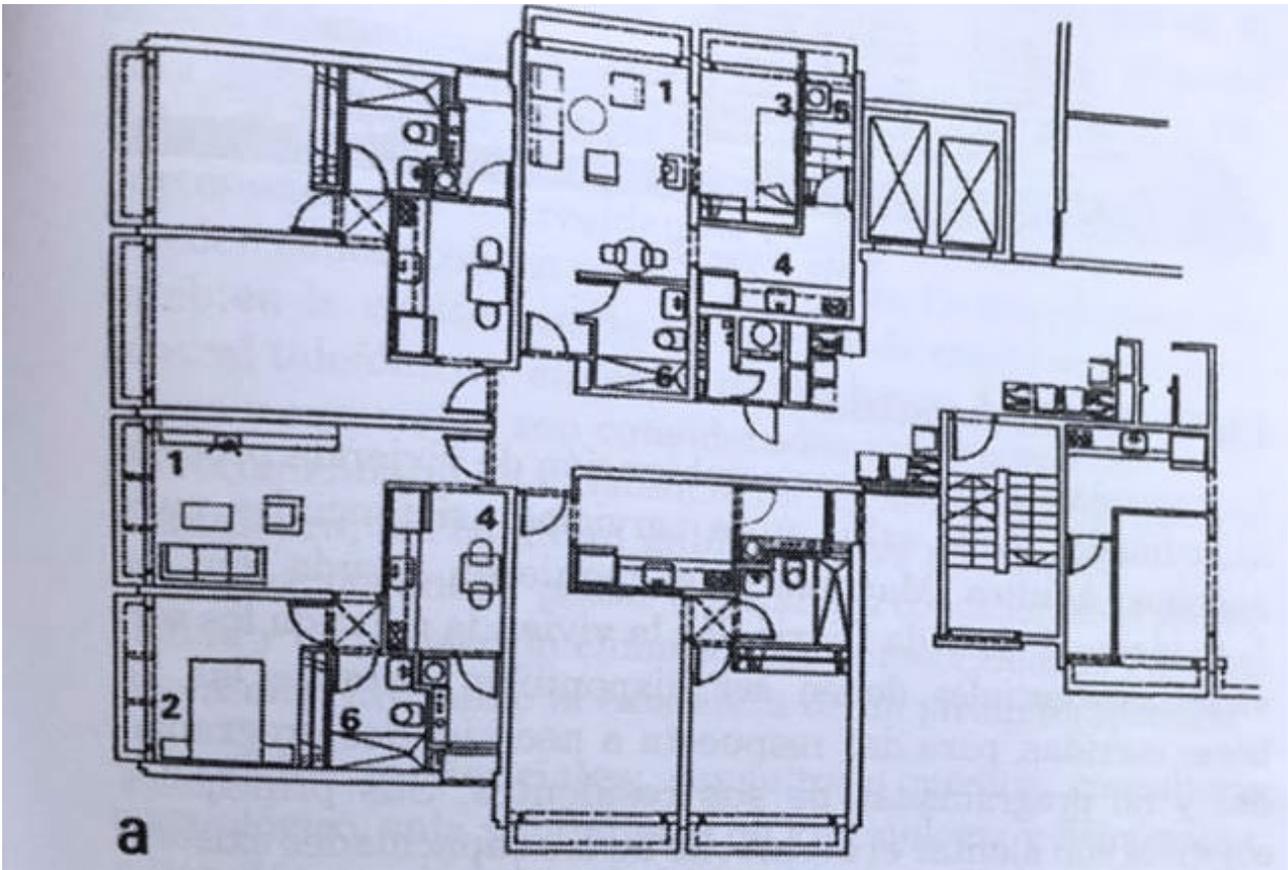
Planta arquitectónica de Departamento de un ambiente y medio.
